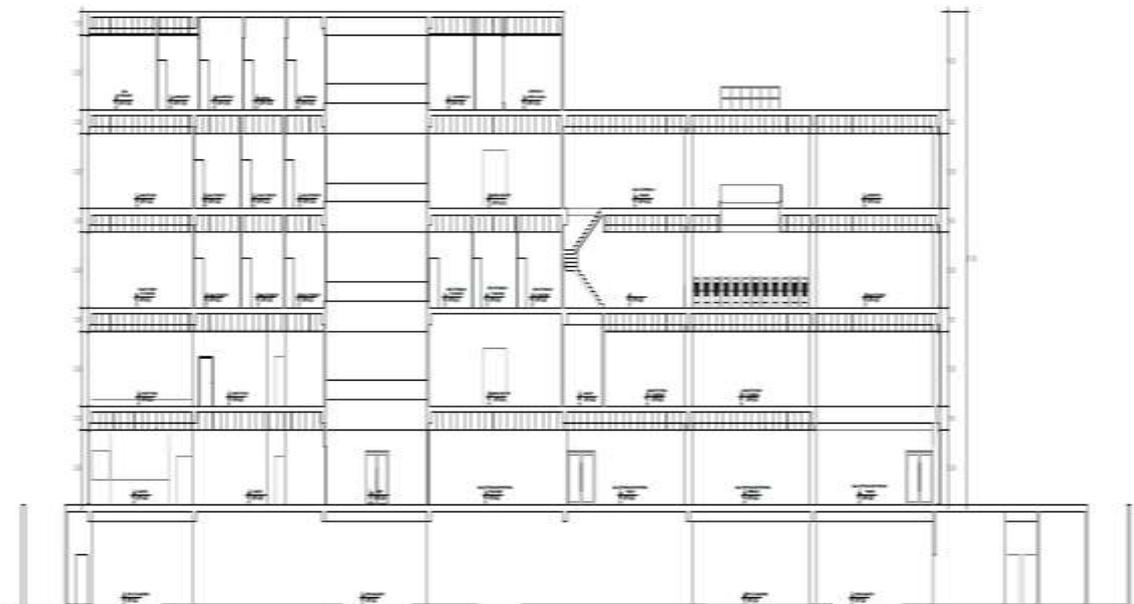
Corte A-A de la propuesta de Centro Cultural.
